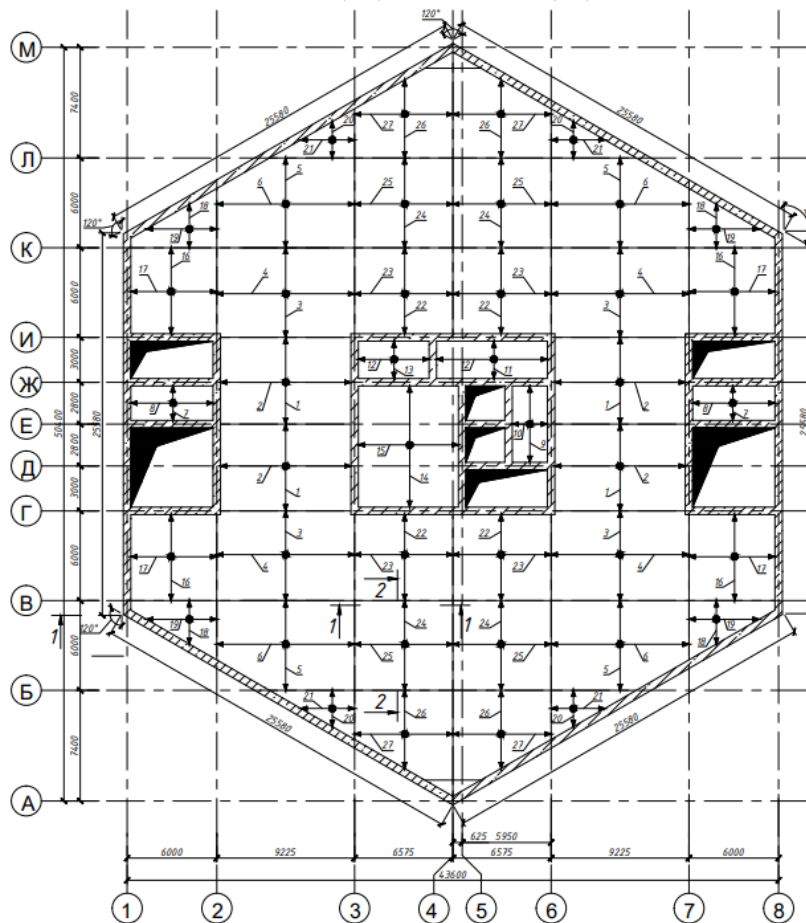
Схема расположения железобетонных стен и ядер жесткости
